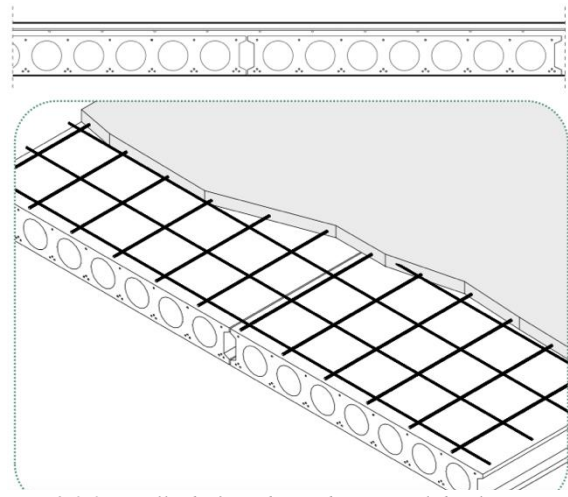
Detalle de forjado unidireccional de placas alveolares
